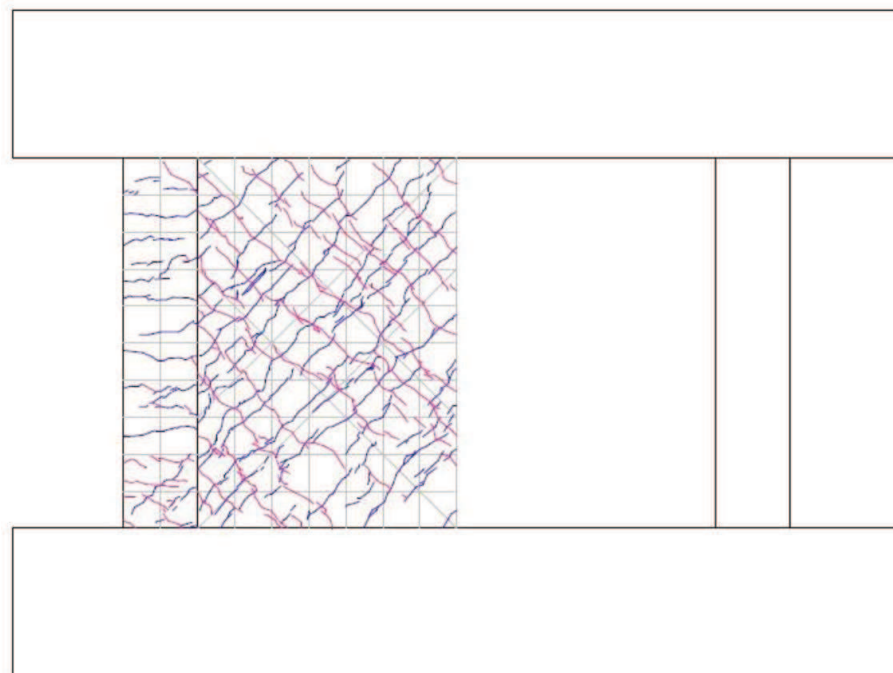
試験体 S-13-DII 事前加力終了時 (2/1000rad.) ひび割れ図
